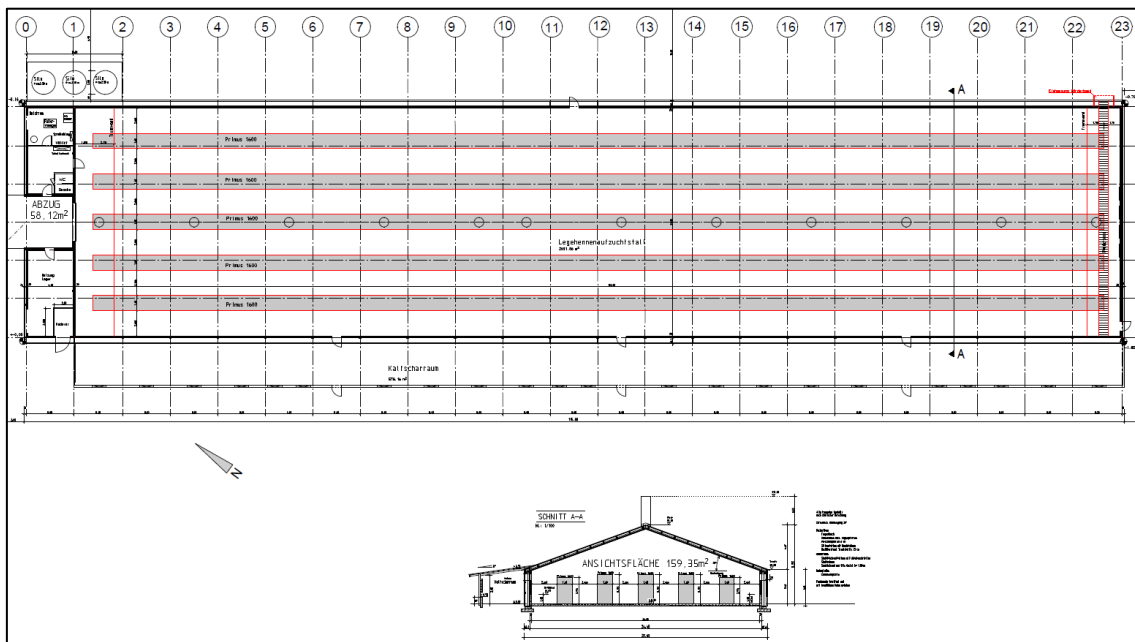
Stallgrundriss des Junghennenaufzuchtstalles (Ingenieurbüro Rausch und Partner)
